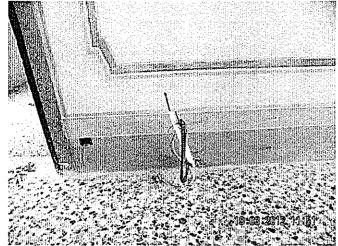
Stanza 1.5 (sala)- Particolare impianti posati
